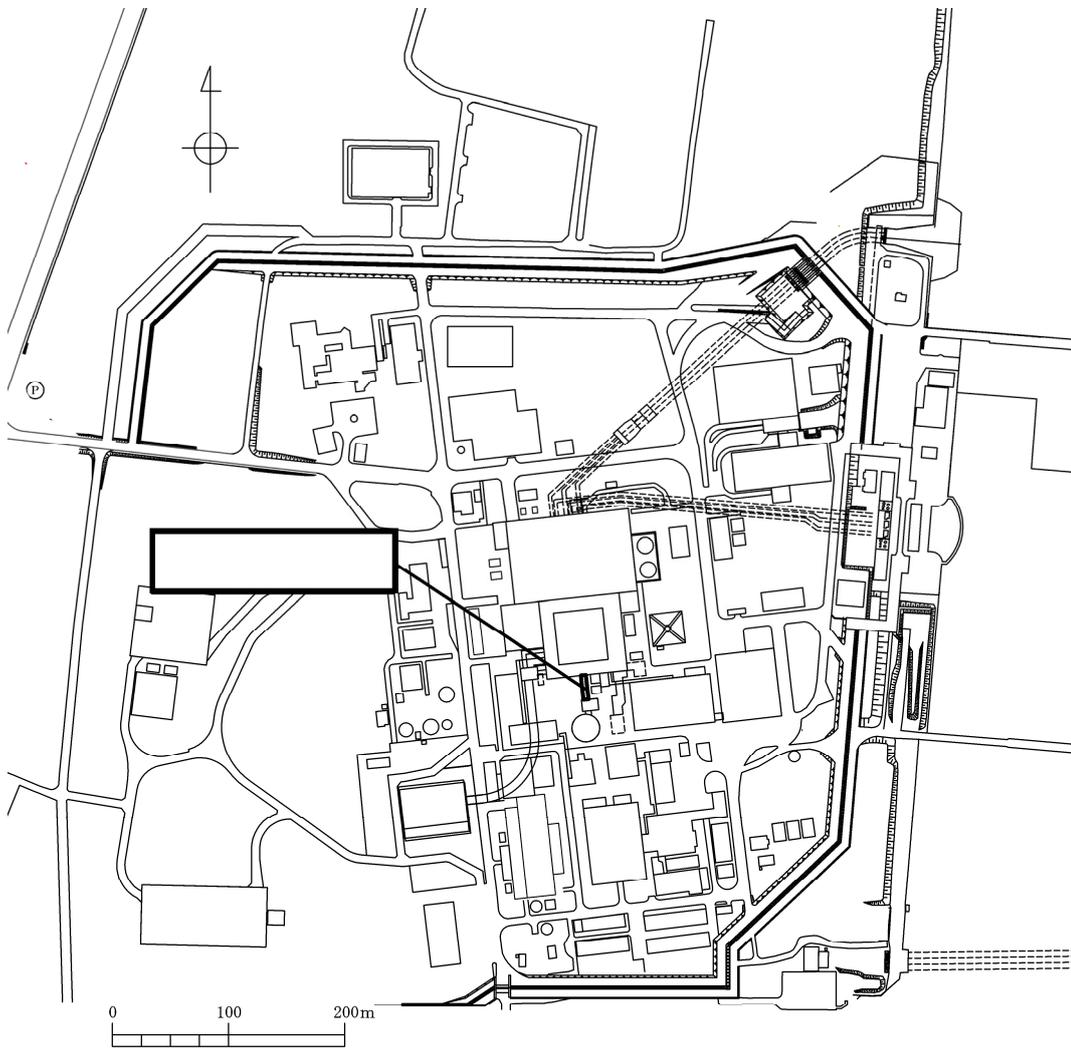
(1) 常設代替注水配管カルバート 平面位置図 (全体平面図)
